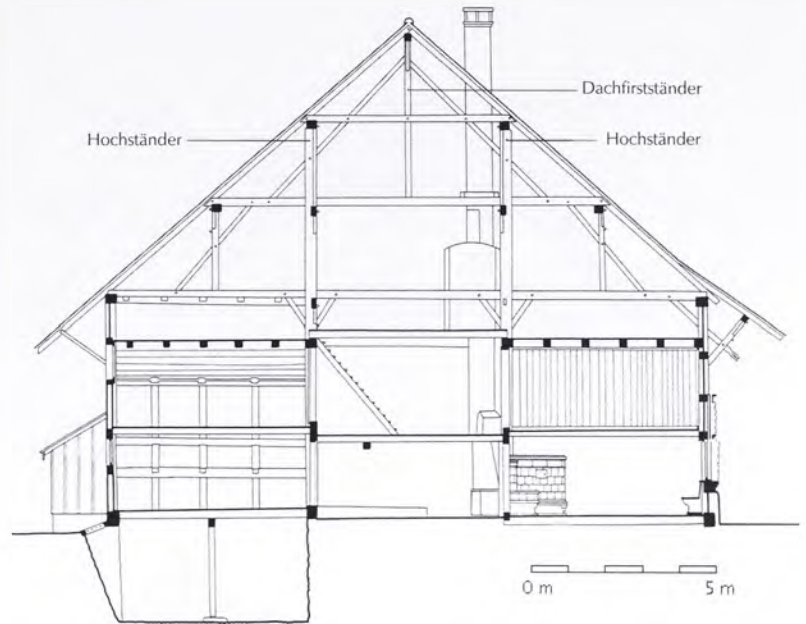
Hochständergerüst mit Dachfirstständerreihe, Kloten (Kt. Zürich), „Büchelerhaus“, 1548 (i).
